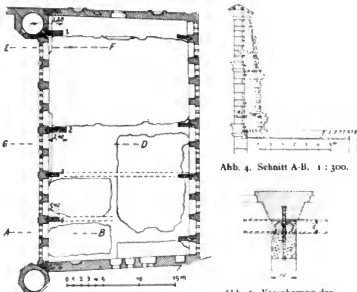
Grundriss. — Massstab 1:500.
